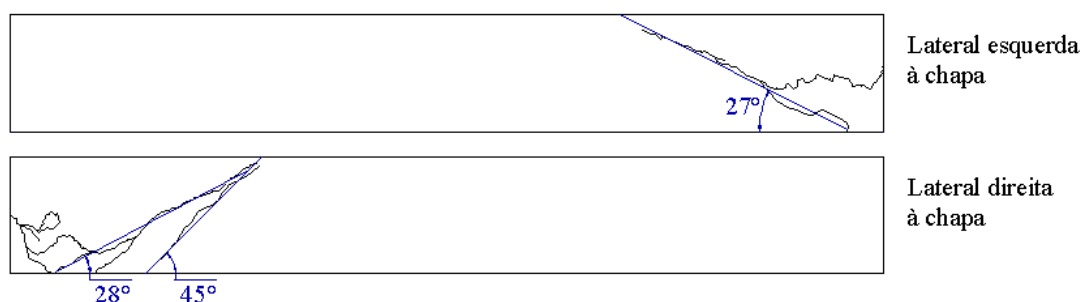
Fissuração na viga V1 e inclinações das fendas
